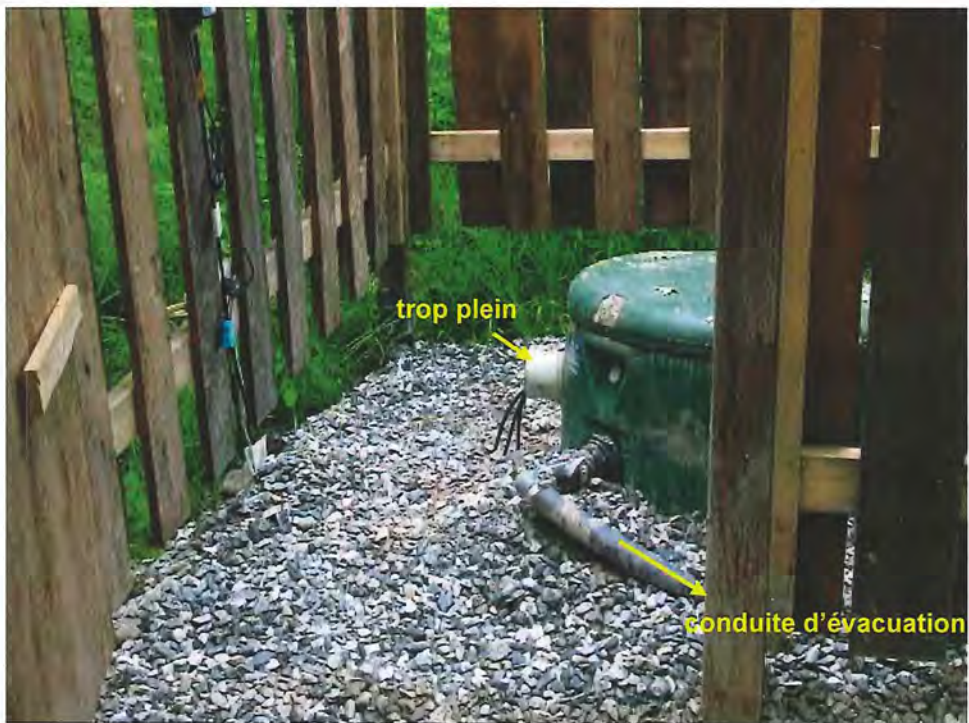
Nouvelle station de pompage 1A située au sud du site 517
